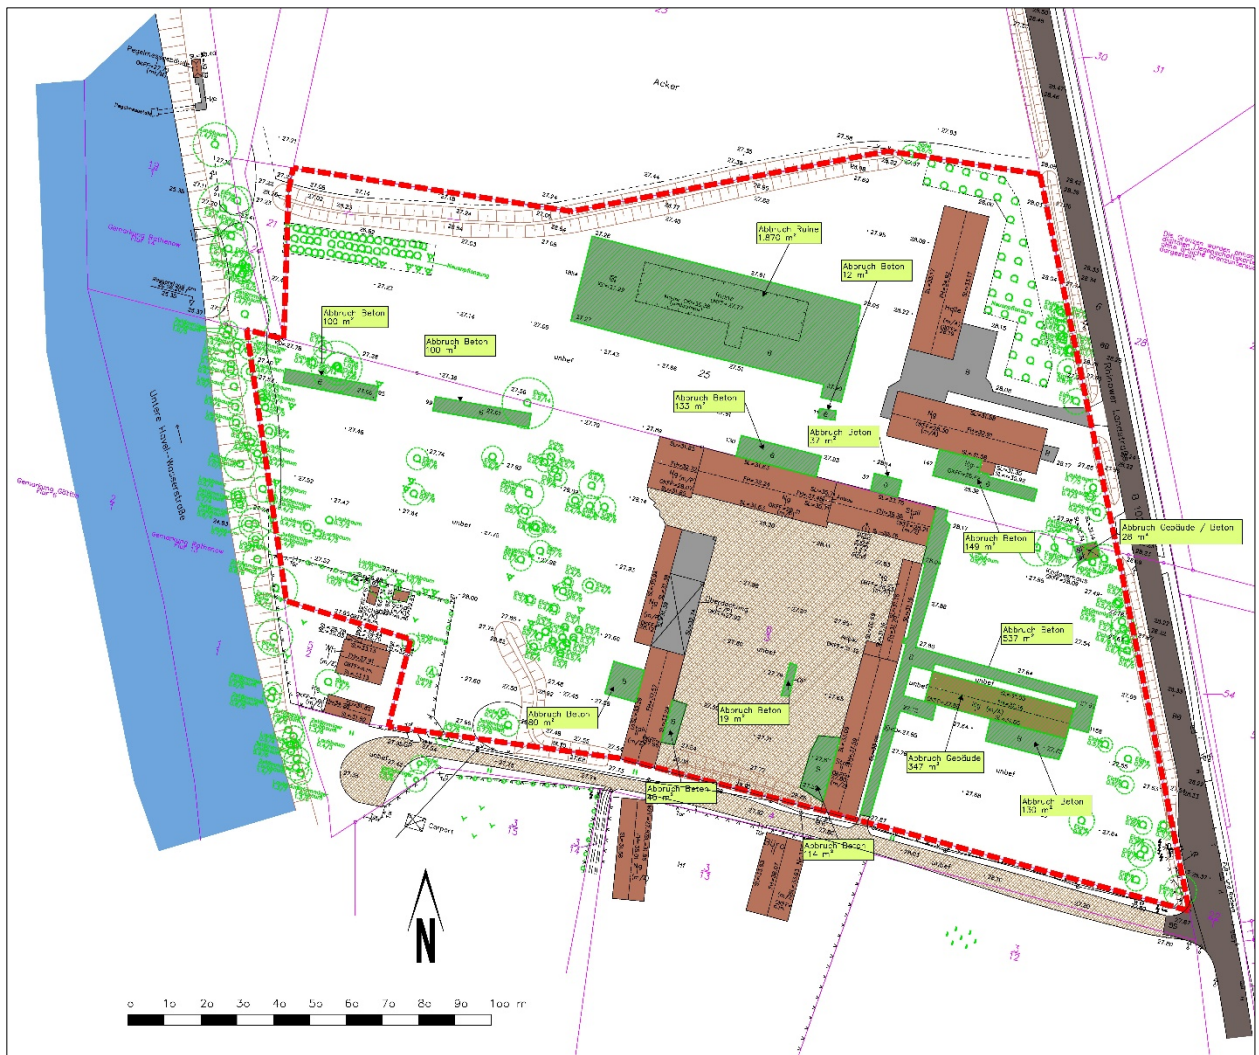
Bestandsvermessung mit Darstellung der Bebauung und Flächenbefestigung; Grundlage amtlicher Lageplan 11 / 2017 (ohne Maßstab)
